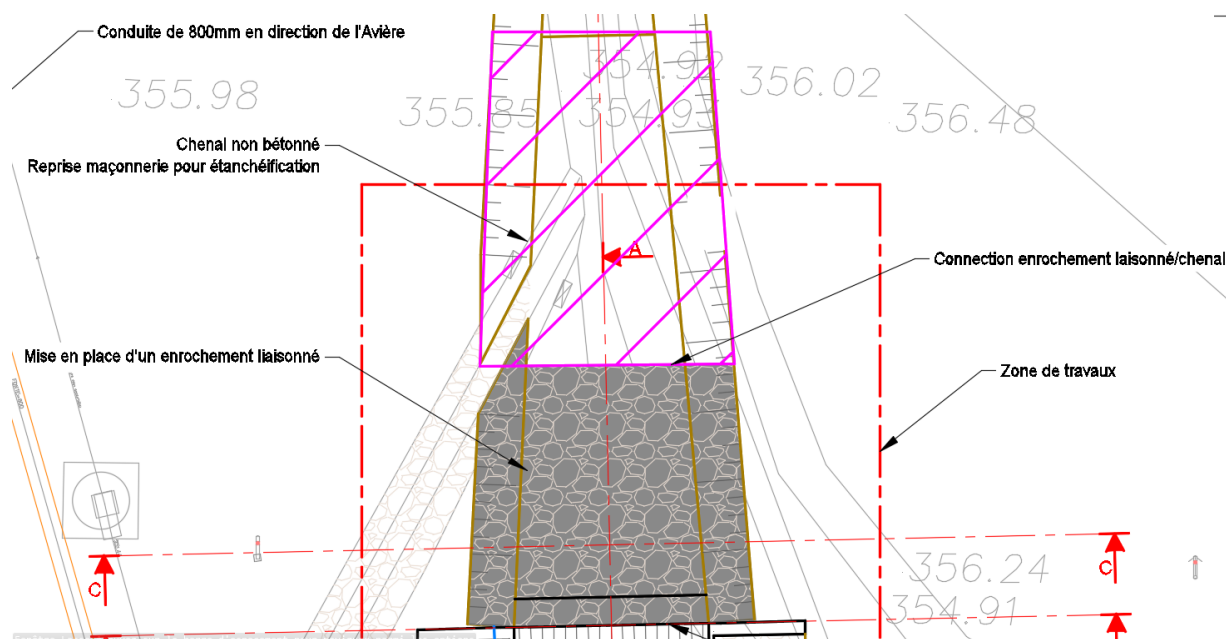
Vue en plan des travaux de rejointoiement à réaliser
